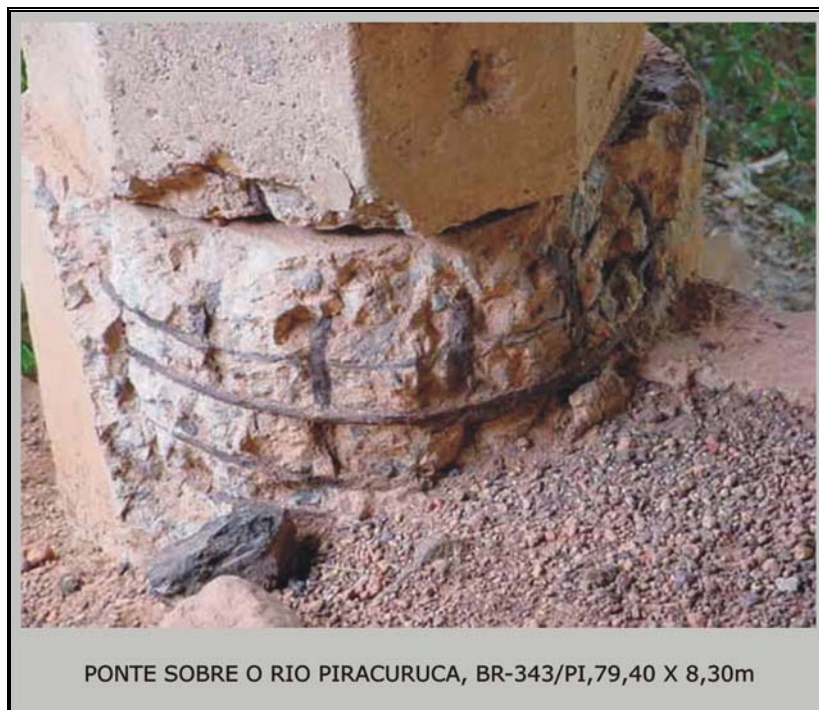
Detalhe do pilar com deslocamento de concreto e corrosão de armaduras
